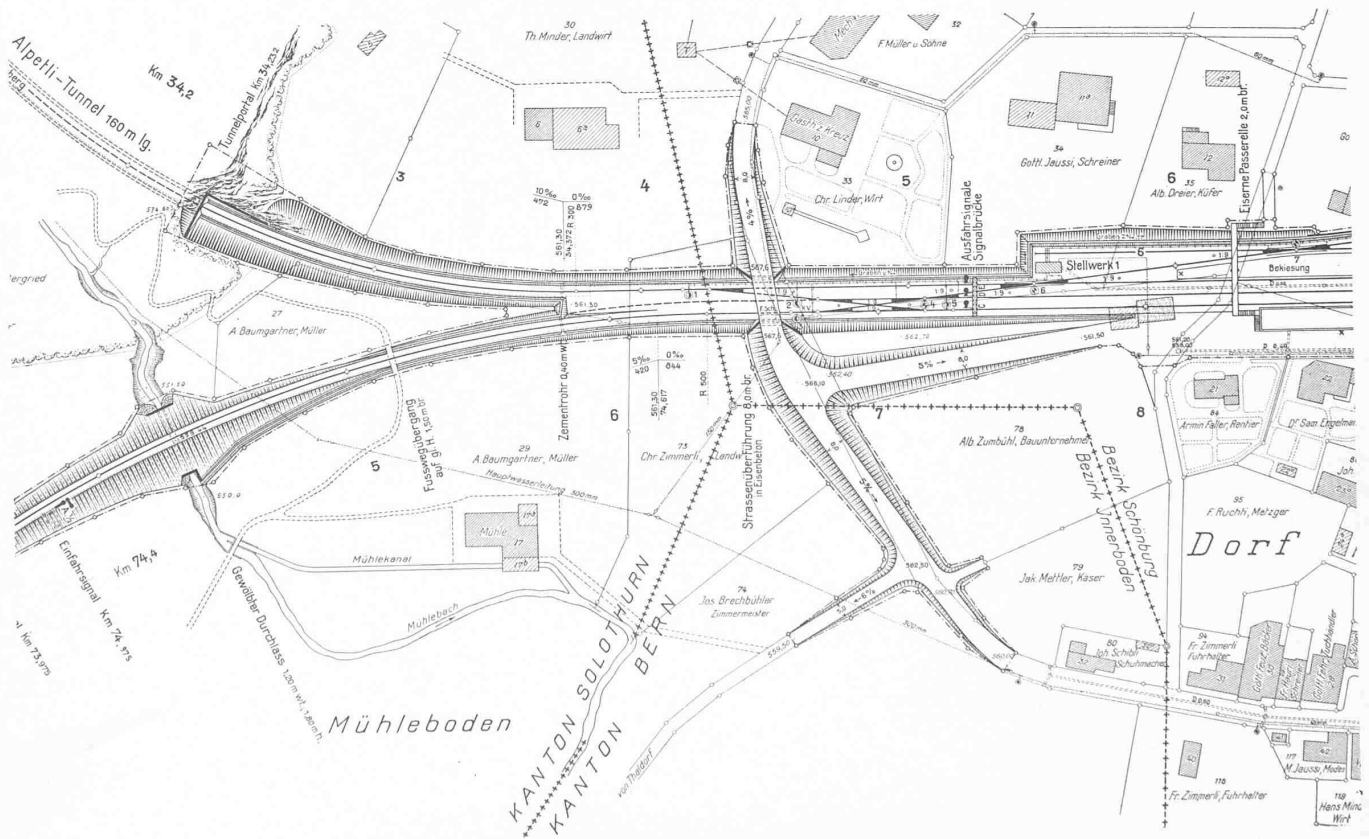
Ausschnitt aus dem Lageplan-Blatt, Original-Masstab 1:1000, verkleinert auf 1:2500. — Original-Zeichnungen von † F. Leiber.
